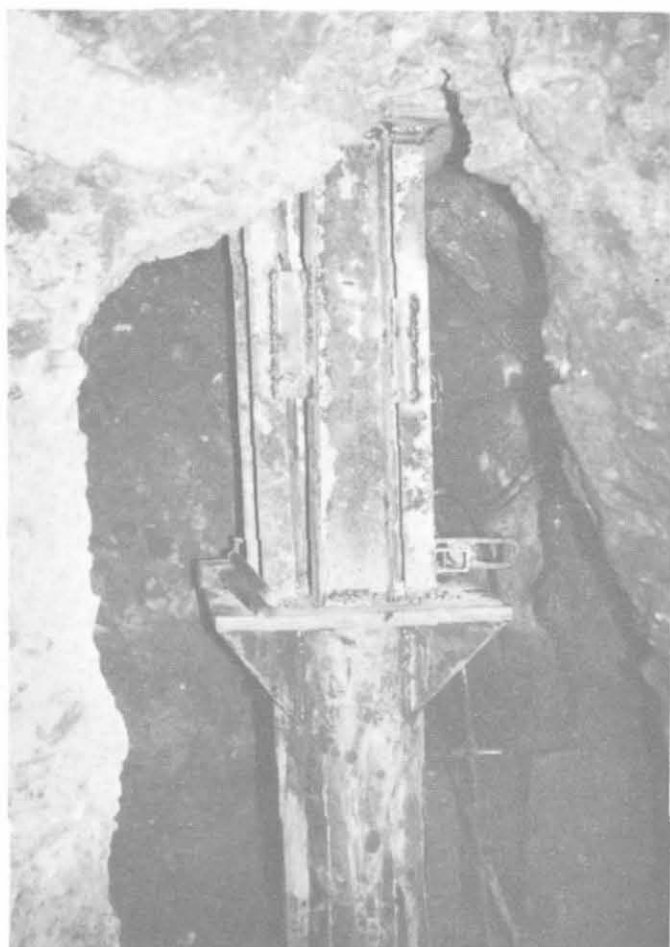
Sottofondazione con pali pressoinfissi in fori predisposti.
